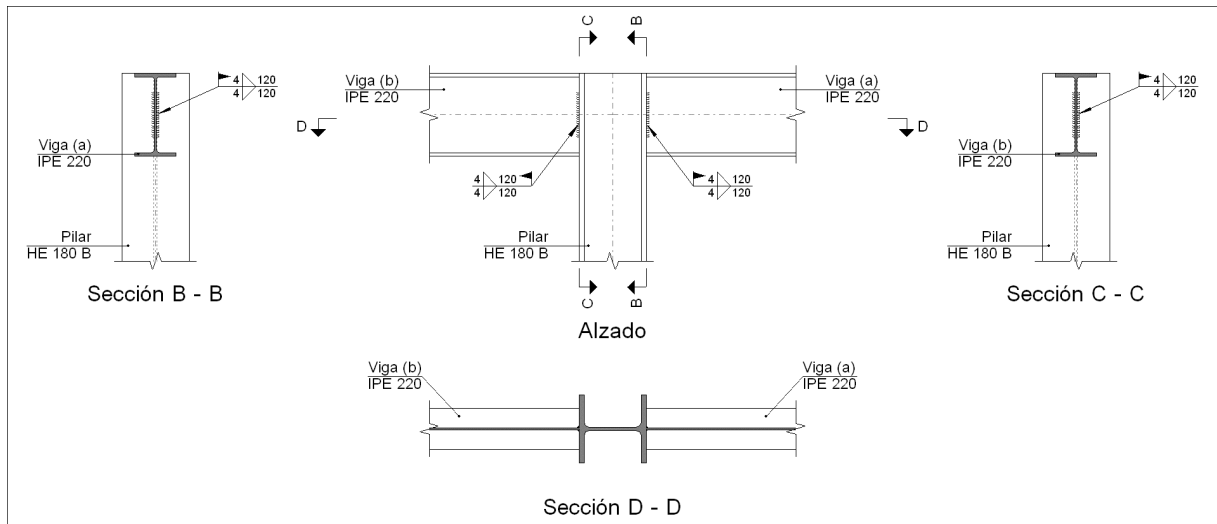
Detalle de las soldaduras tipo 5 del soporte inferior
